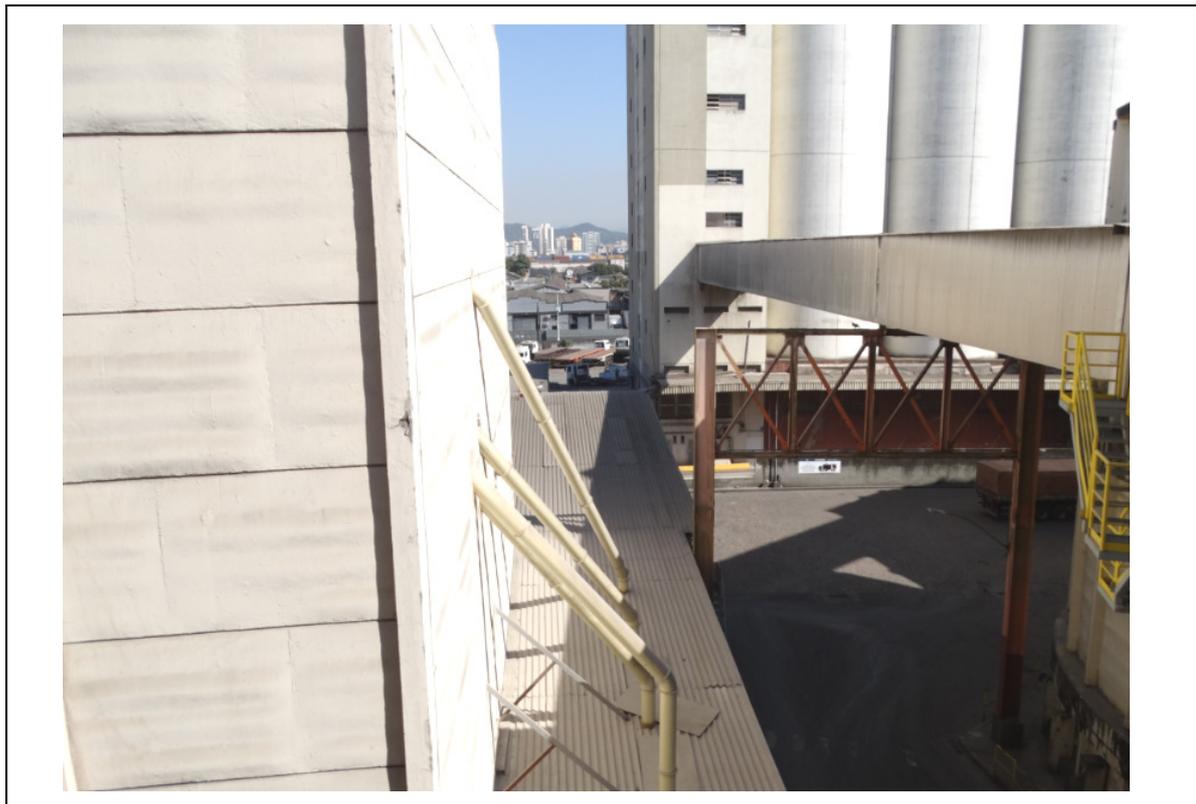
TRECHO DA FACHADA DO PRÉDIO H1/H2.
